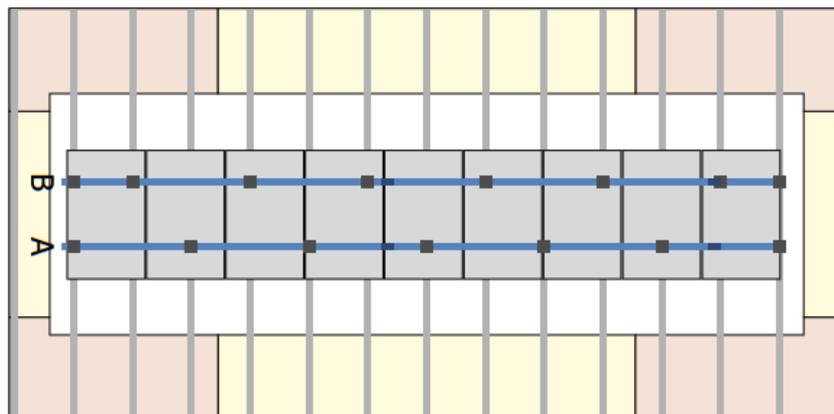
Plano de la instalación con 9 paneles fotovoltaicos
